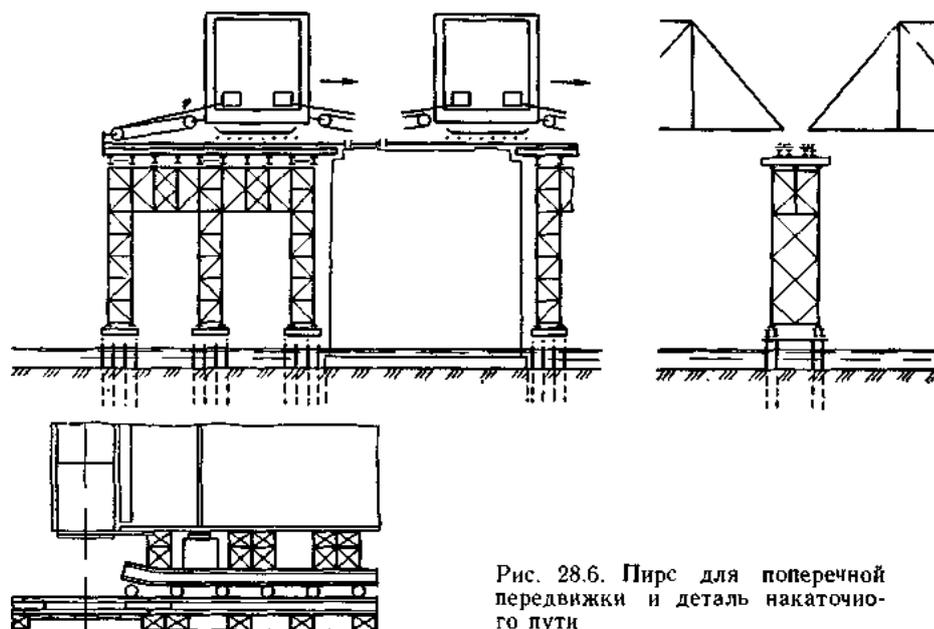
Пирс для поперечной передвижки и деталь накаточного пути
